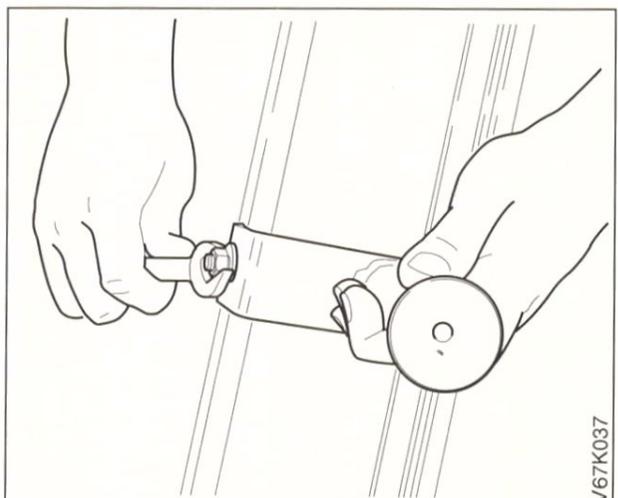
Tragegriffe liefern wir auf Wunsch. An beiden Seiten des Kollektors so befestigen, daß Hammerkopfschrauben rechtwinklig in der Nut sitzen. Bitte beachten Sie beim Kollektortransport die VBG 37, Bauarbeiten!
